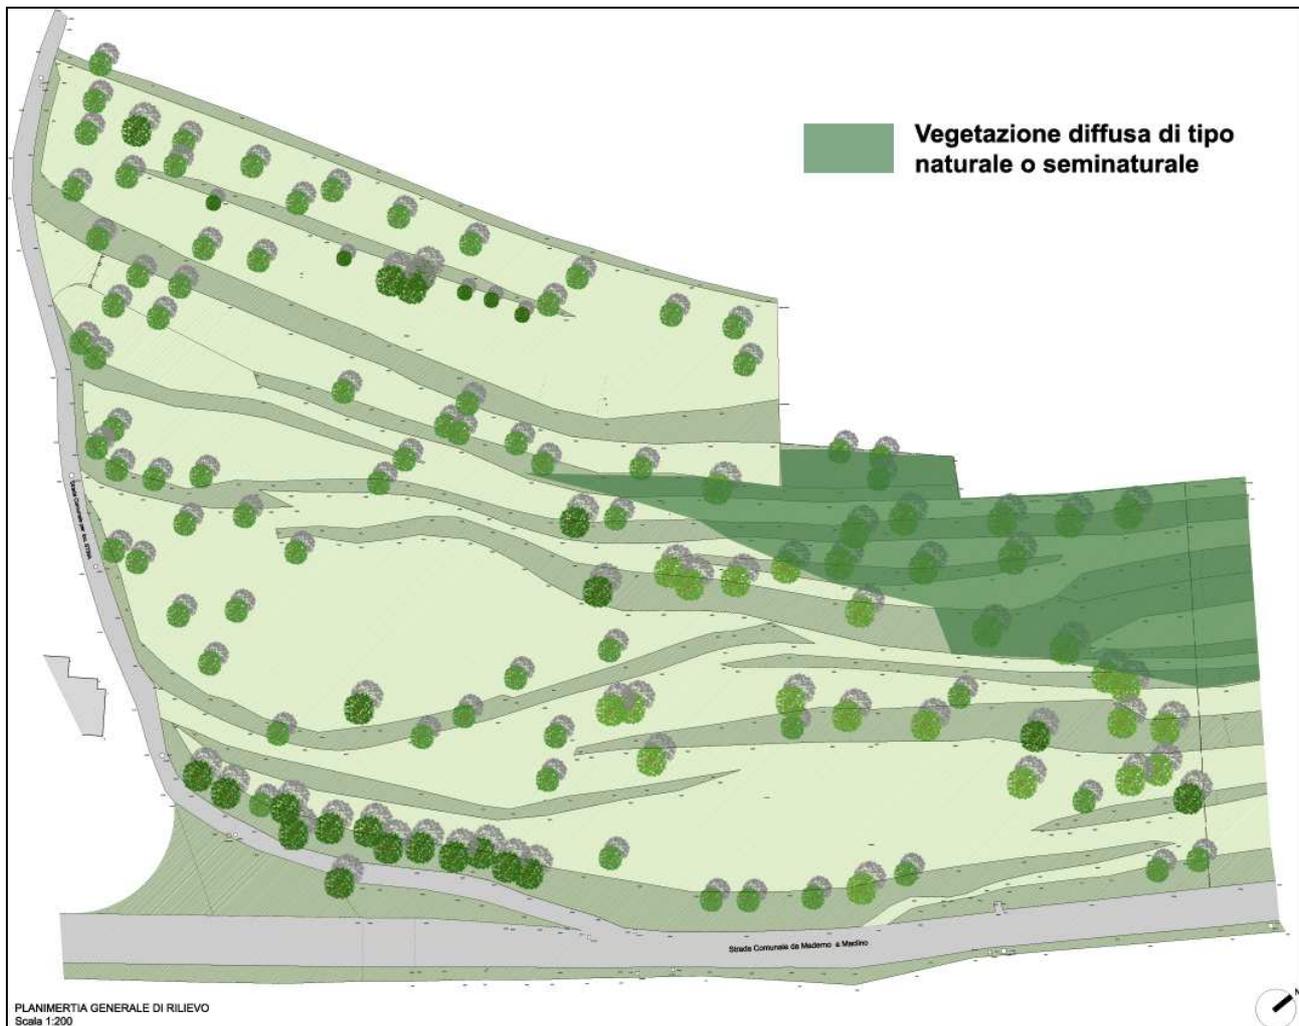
Individuazione delle “Vegetazione diffusa di tipo naturale o seminaturale”.
